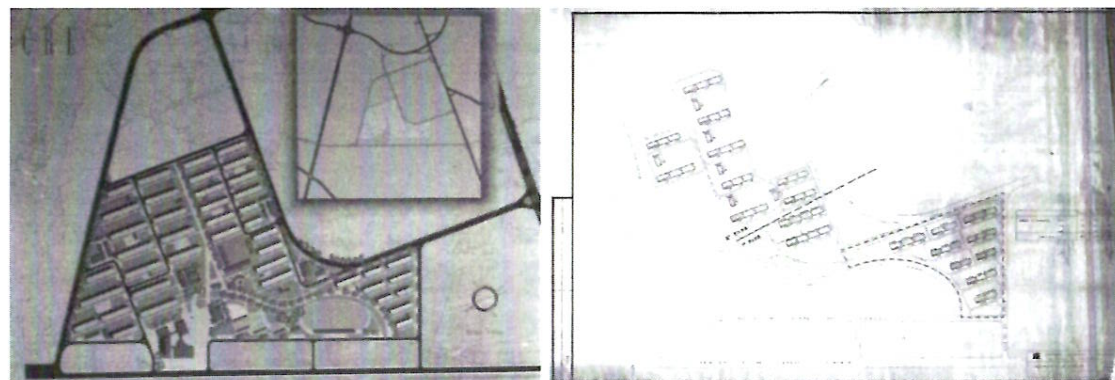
Plano de Situación inicial (imagen publicada in Trigueiros, Luiz, ed.. 1993. Fernando Távora. Lisboa: Blau)
